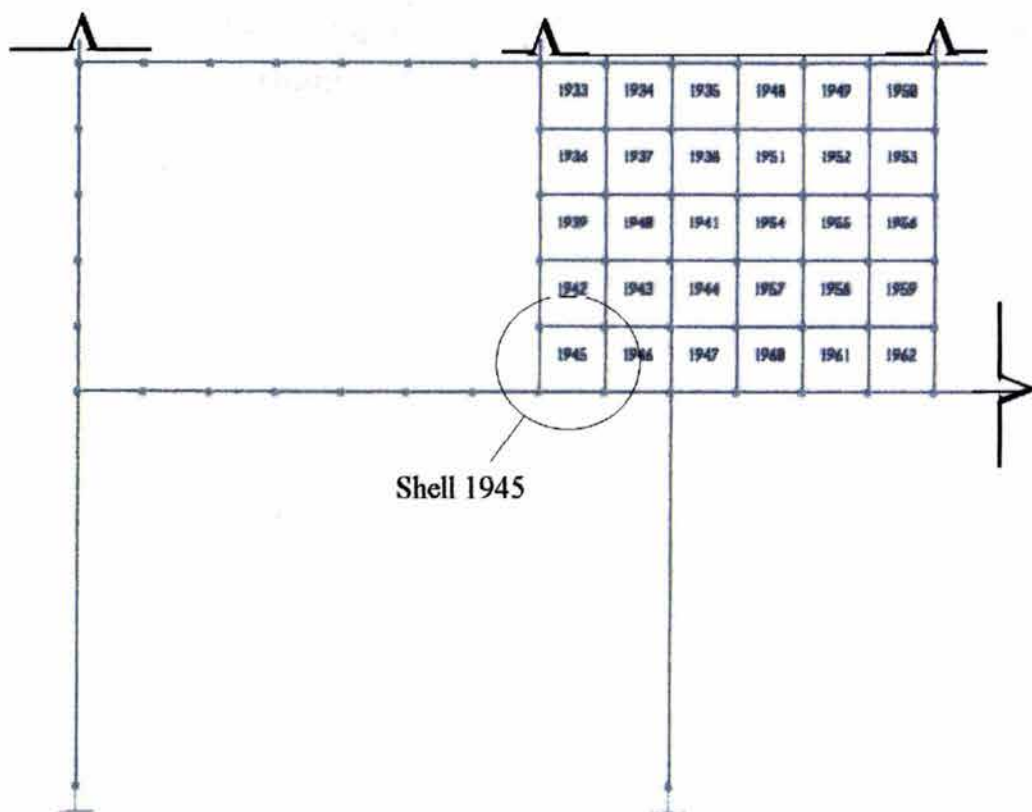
Partición del muro 20 en el Plano Y=0.
